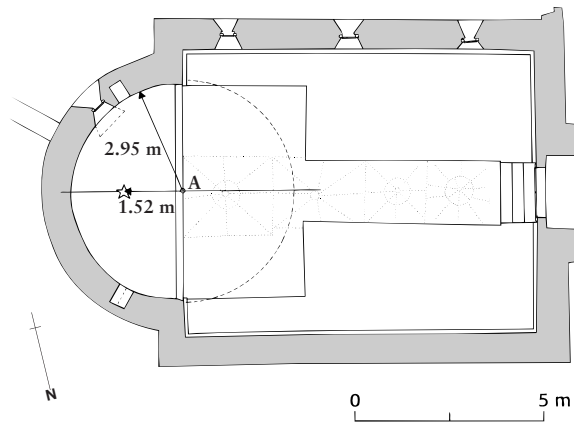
Evangelische Filialkirche Garsun. Grundriss mit eingezeichnetem Kreis (Radius 2,95 m) und optimaler Sprecherposition (Stern). Mst. 1:200.
